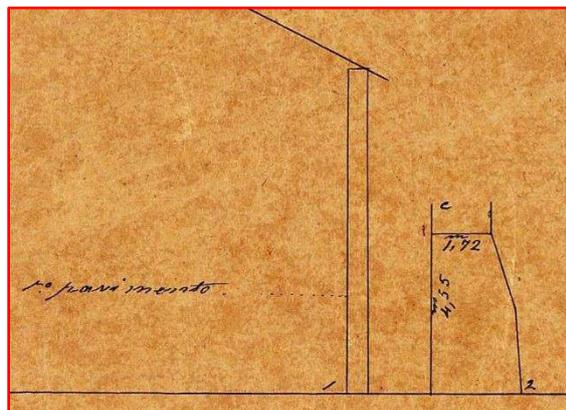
Desenho de “Corte” na muralha. Pormenor da Figura 5.
